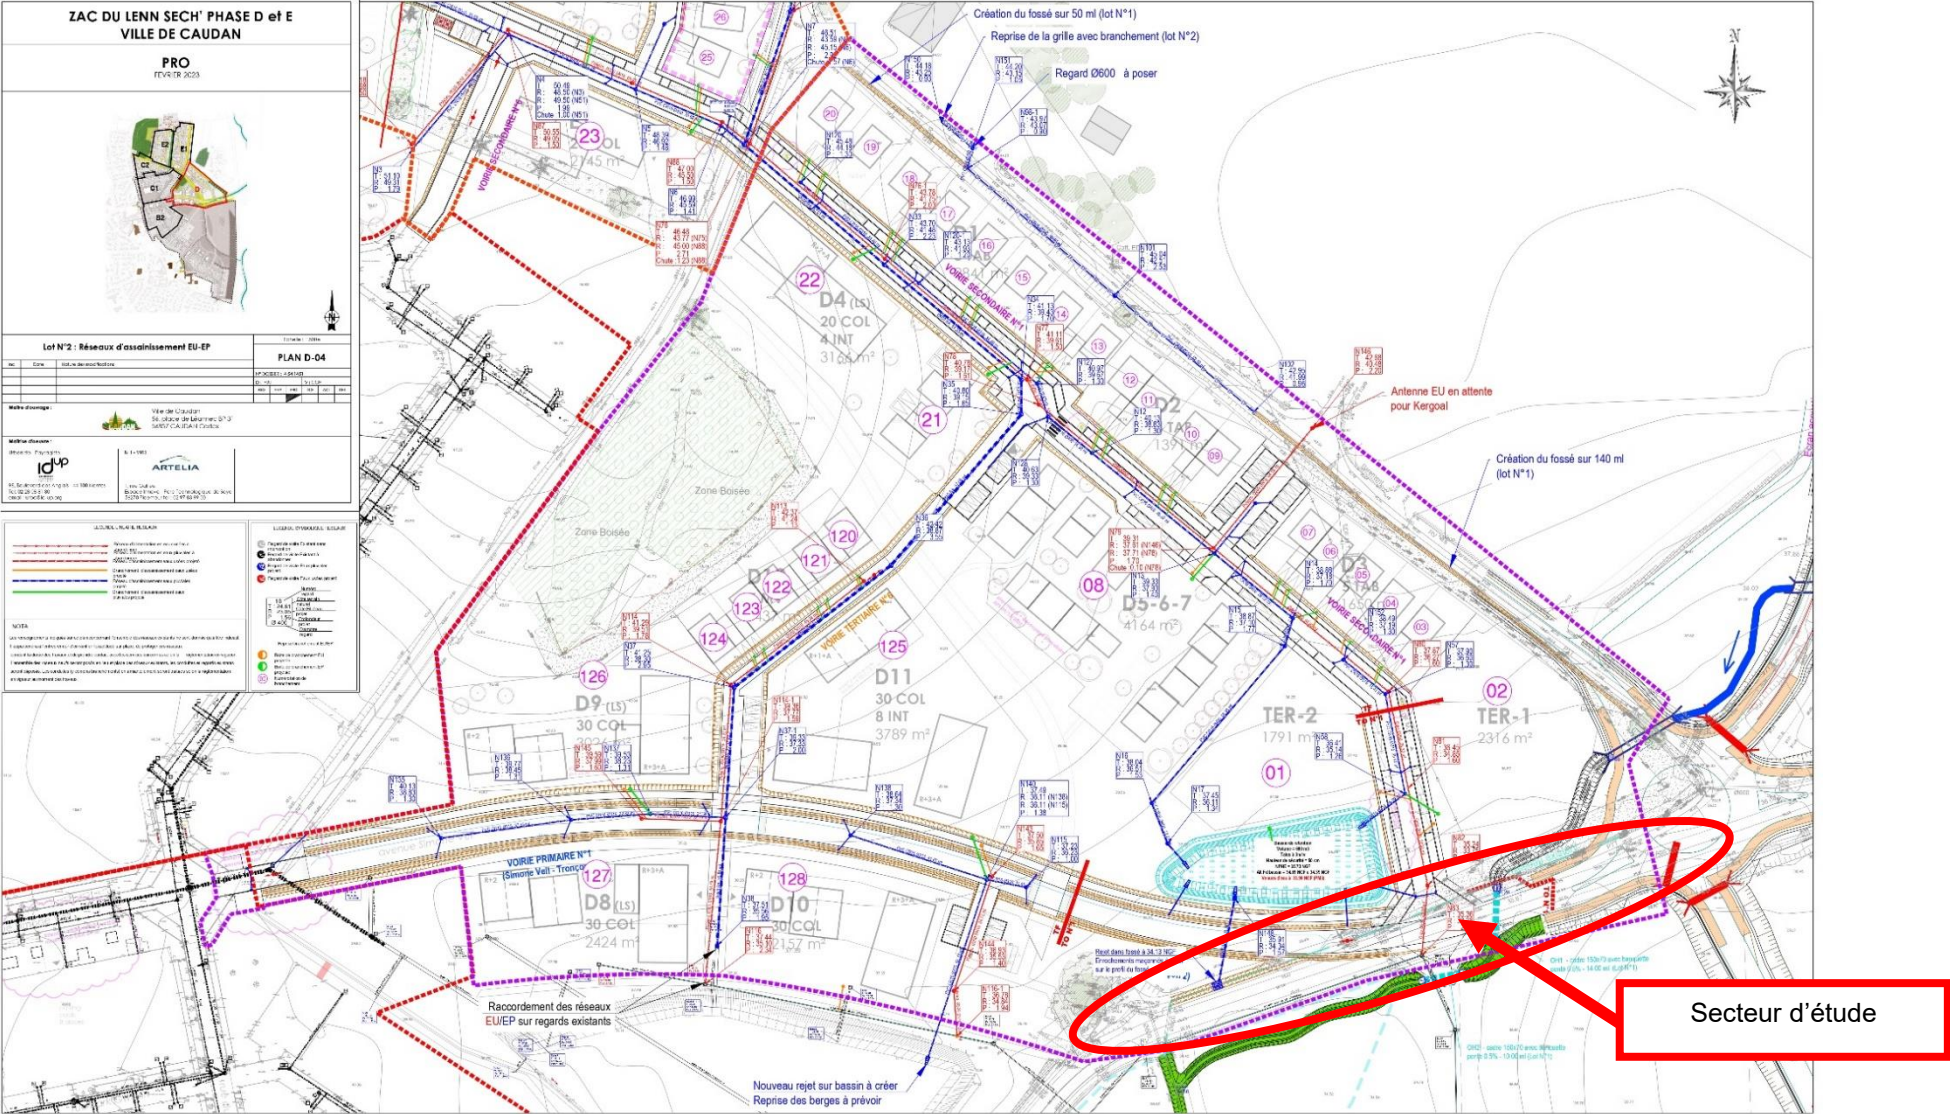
Plan projet de la ZAC Lenn Sec'h (Source Commune de Caudan)
